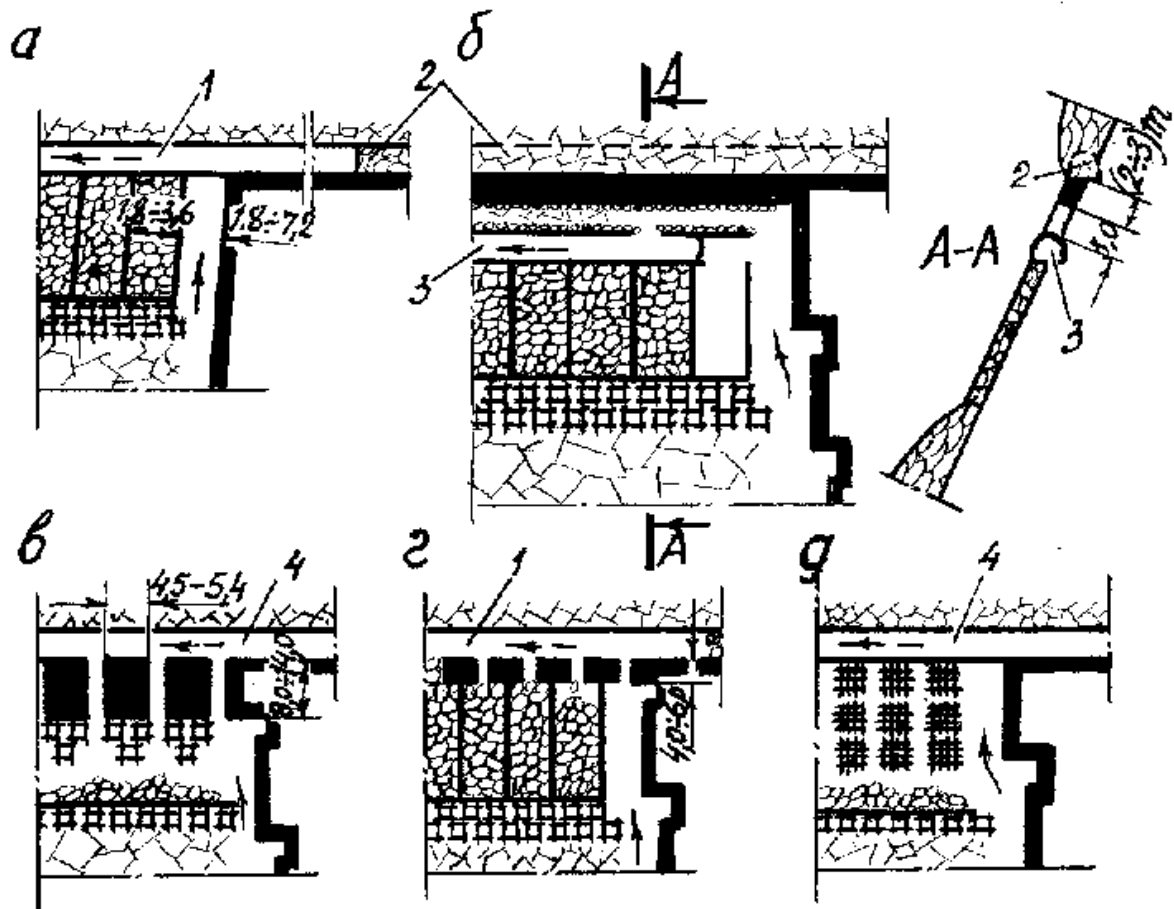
Технологические схемы охраны вентиляционных штреков при сплошной системе разработки крутых пластов:
